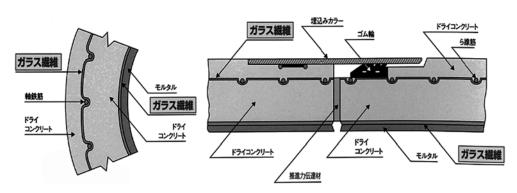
ガラス繊維鉄筋コンクリート管の管体構造図
